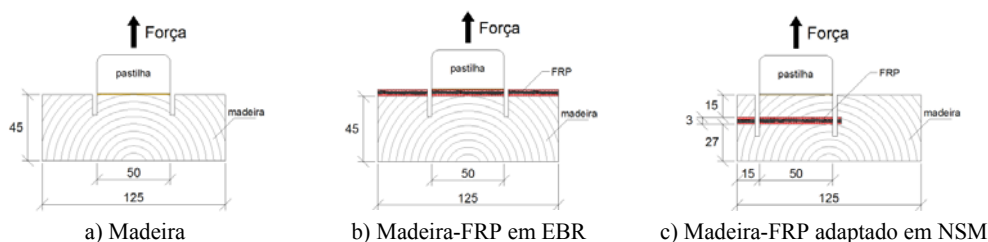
Modelos de ensaio "Pull-Off"- tipos de junta.
